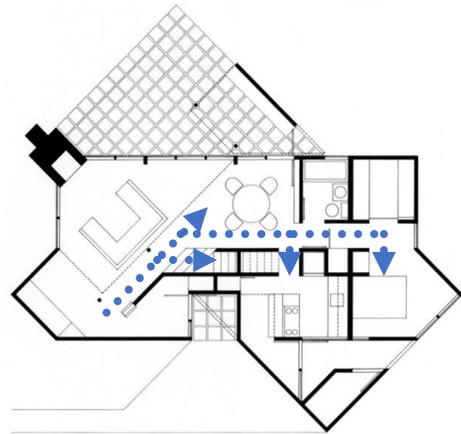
Planta Baja Casa Hoffman Consultada en: <http://www.richardmeier.com/?projects=hoffman-house>
